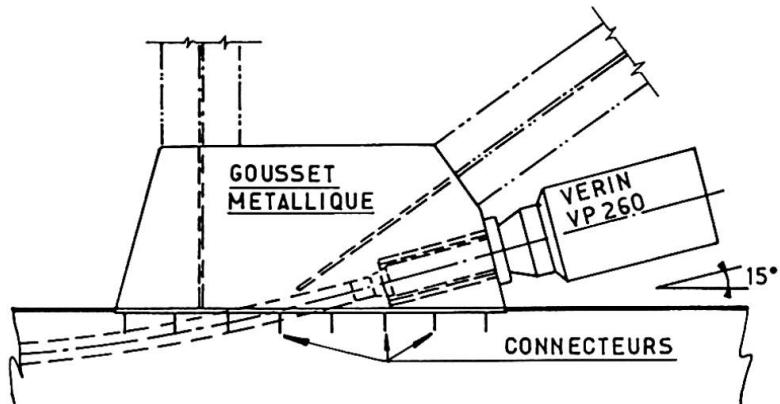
Gousset métallique servant à l'ancrage d'un câble situé dans le hourdis inférieur.
